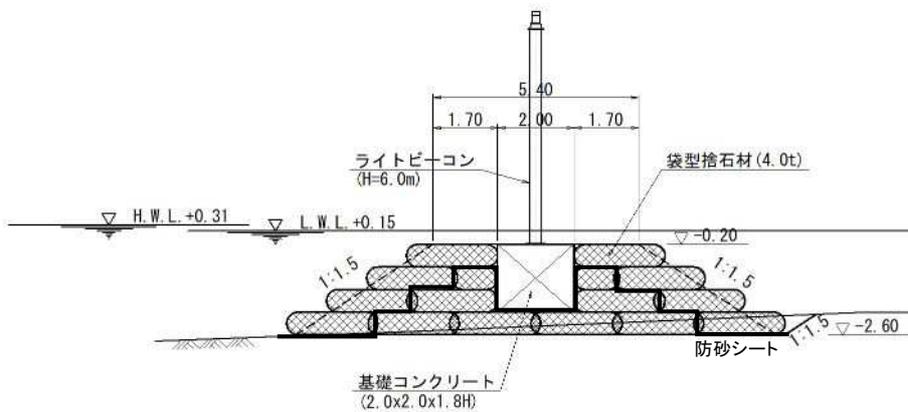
(4) 潜堤本體(暫定時)の先端部断面図
